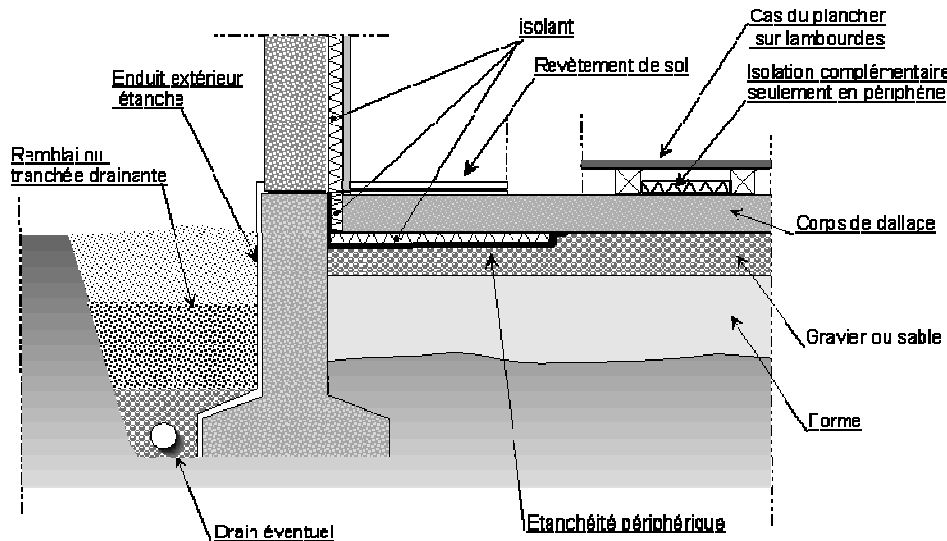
Principe de construction d'un dallage indépendant sur terre plein [Collignan and Sullerot, 2008].
